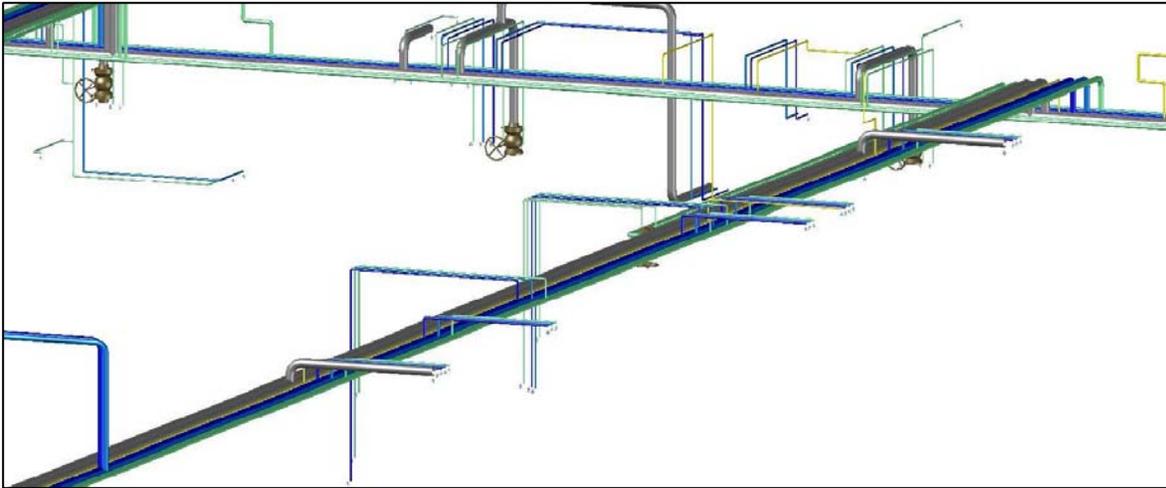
Modelo 3D de Tuberías en Planta Piloto FES Zaragoza (Vista 4).
